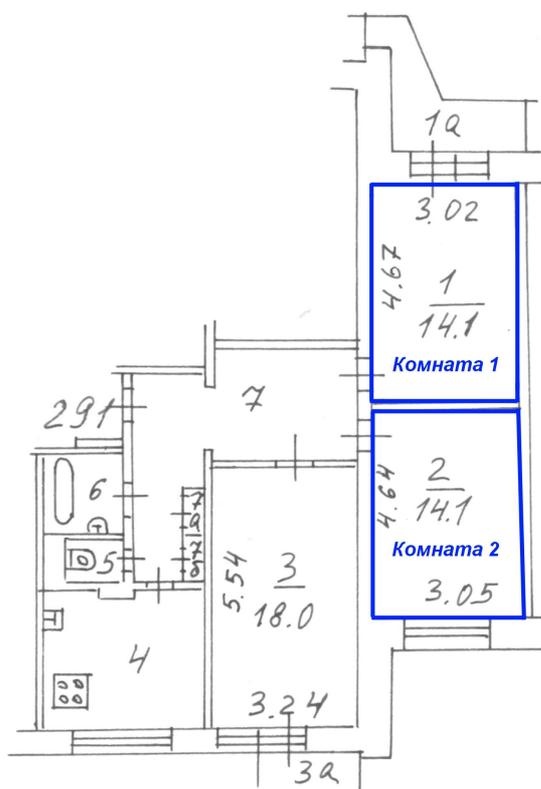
Поэтажные планы квартир у (этаж 9) и х (этаж 10) с указанием помещений, в которых проводились измерения ударного и воздушного шума
